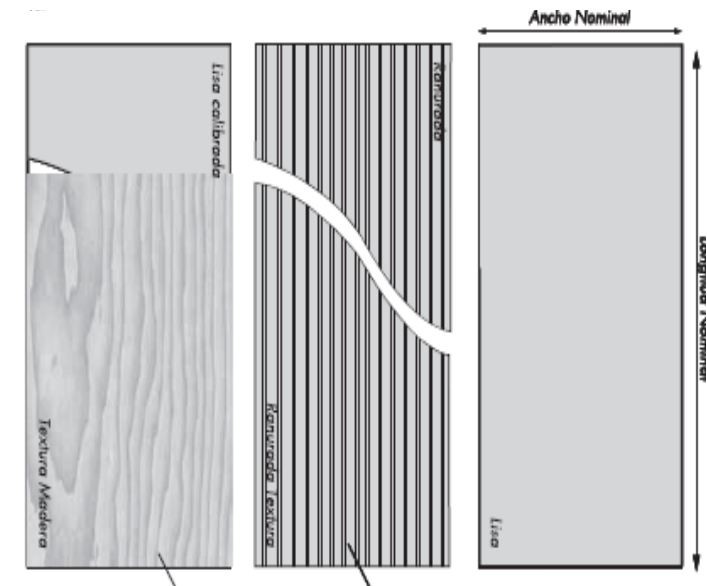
DISEÑO DE LAMINAS O PLANCHAS DE PLYCEM EN EL MERCADO
